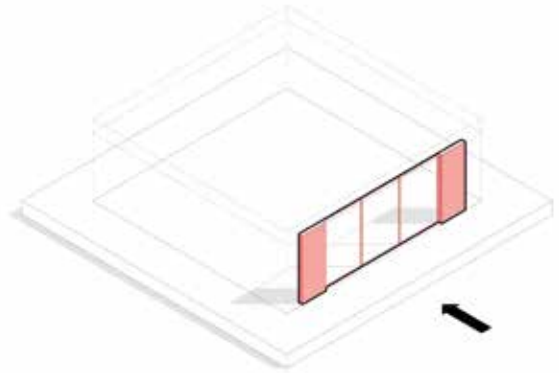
Muro vidriado conecta visual y físicamente el interior con el exterior. Proyecto Future Edu Space
